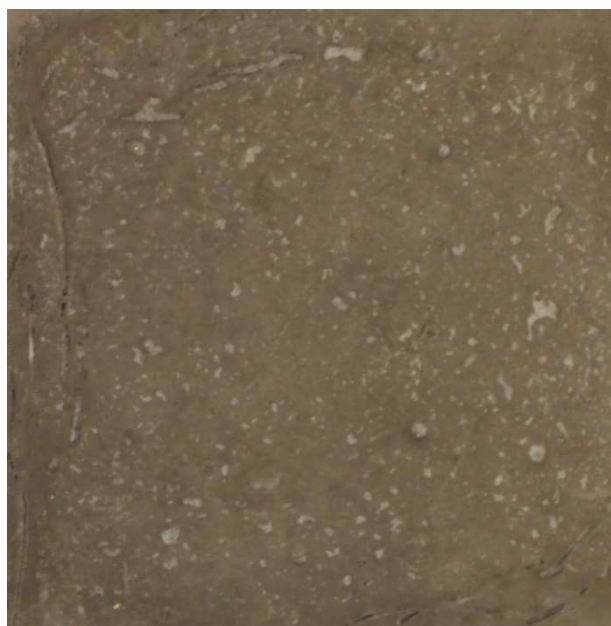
Betonový povrch s netkanou textilní vložkou pro Recepturu II
